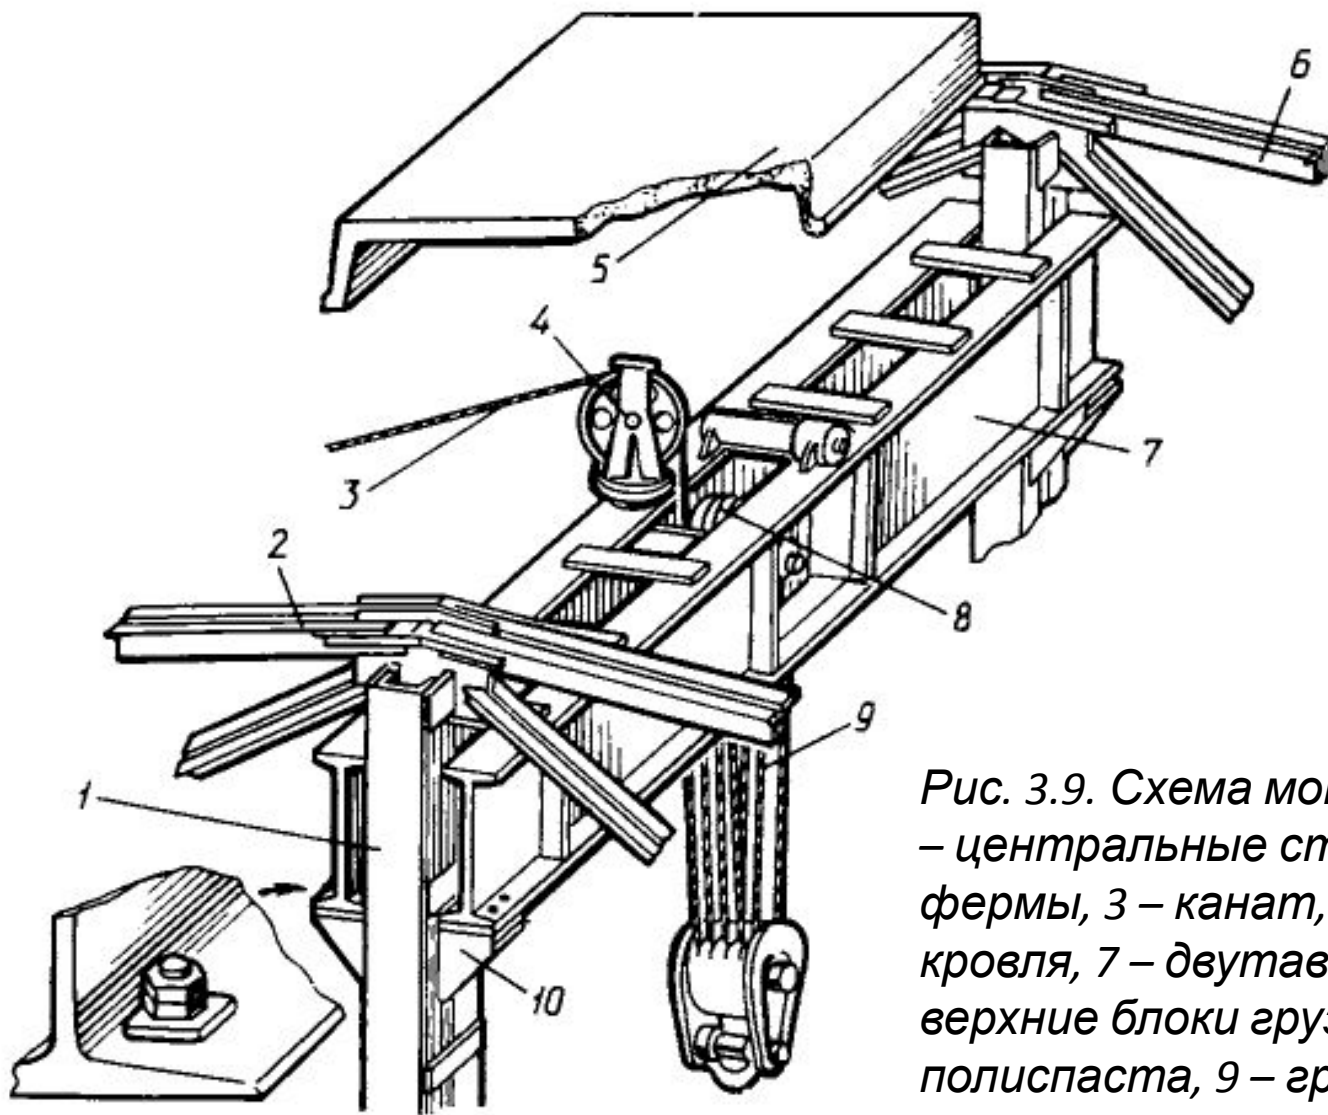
Схема монтажной балки: 1 – центральные стойки, 2,6 – фермы, 3 – канат, 4 – блок, 5 – кровля, 7 – двутавровые балки, 8 – верхние блоки грузового полиспаста, 9 – грузовой полиспаст
